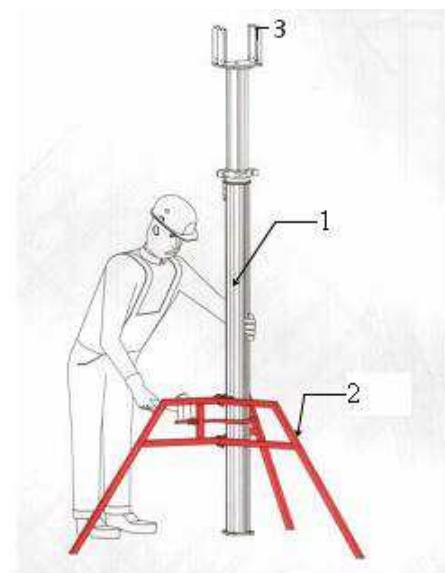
Установка стойки с треногой: 1 – стойка; 2 – тренога; 3 - унивилка
